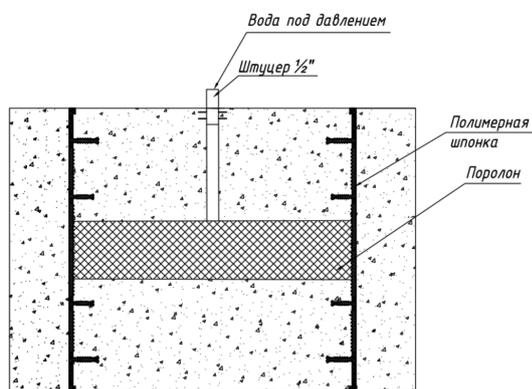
Схема стенда для испытаний гидрошпонки № 1
